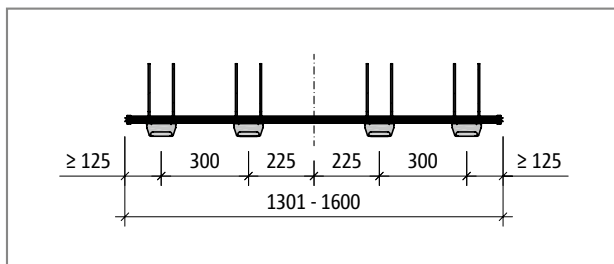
Schöck Tronsole® Typ T-V4-H...-L1301 bis L1600: Produktgrundriss
